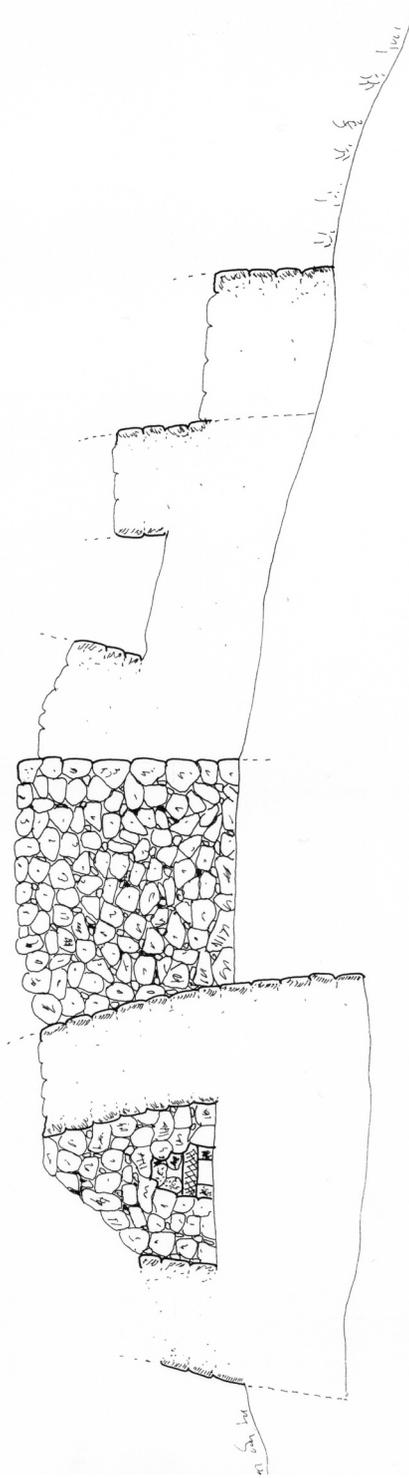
bis - Nuraghe Meurra: sezione longitudinale e prospetto torre b.
